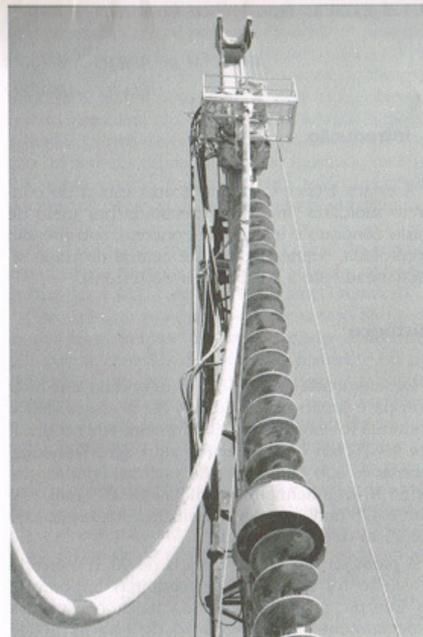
Detalhe da hélice e tubo de concretagem
